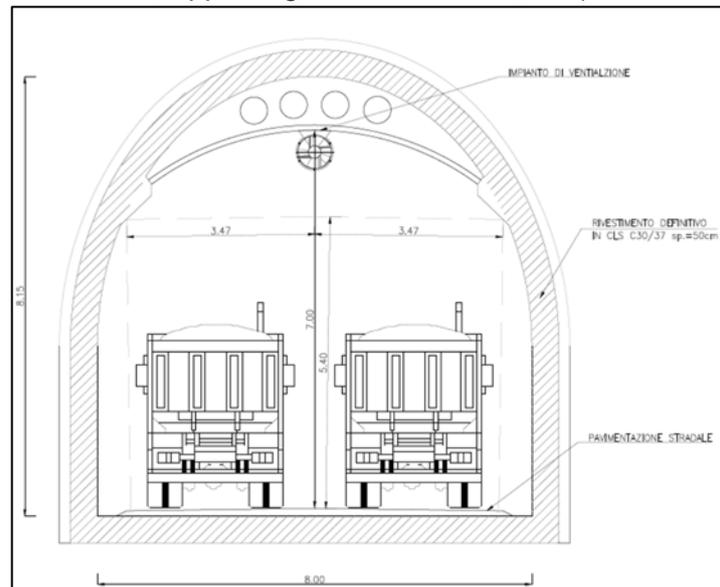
Sezione tipo della galleria di accesso alla centrale
